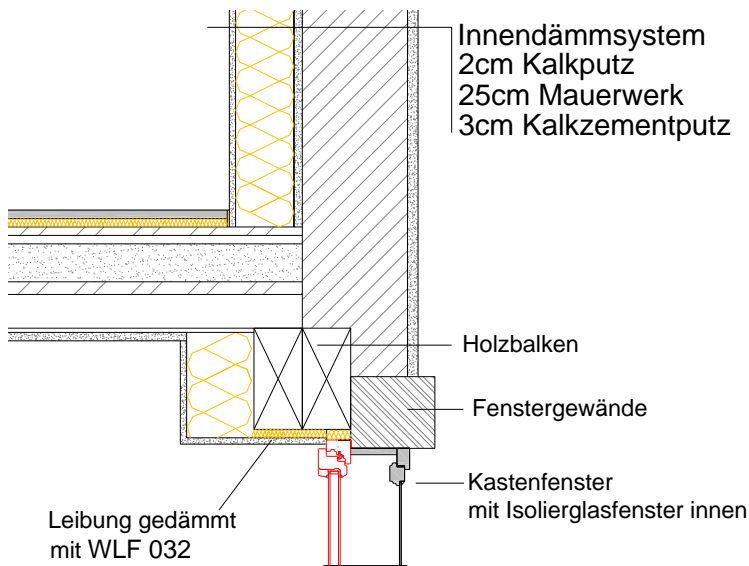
Fensterdetailanschluss Sturz bei Kastenfenster mit Isolierglasfenster innen bei Innenwärmedämmung
